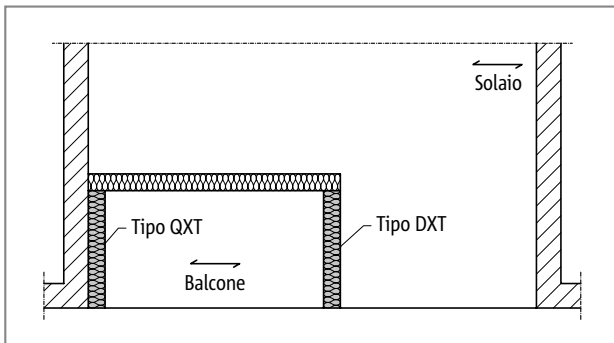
Schöck Isokorb® tipo DXT, QXT: solaio monodirezionale
